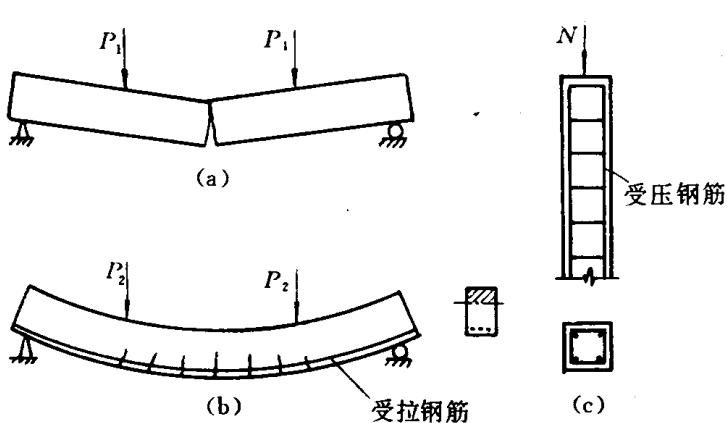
素混凝土梁及钢筋混凝土梁、柱
